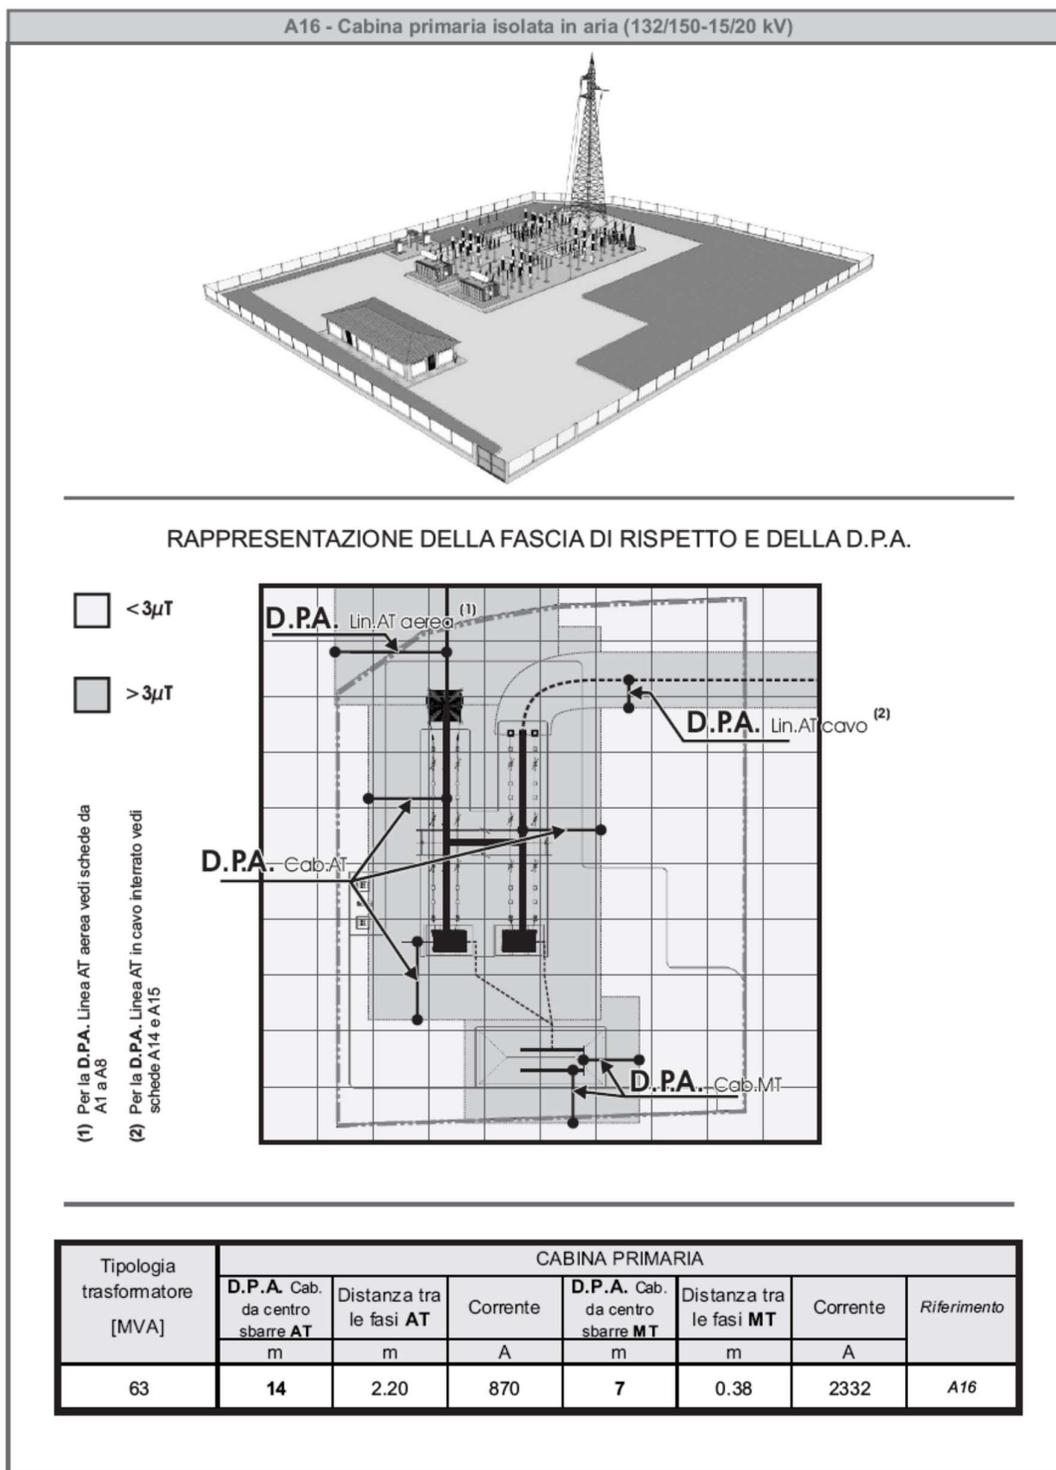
Fasce di rispetto (pubblicazione ENEL Distribuzione S.p.A.)
